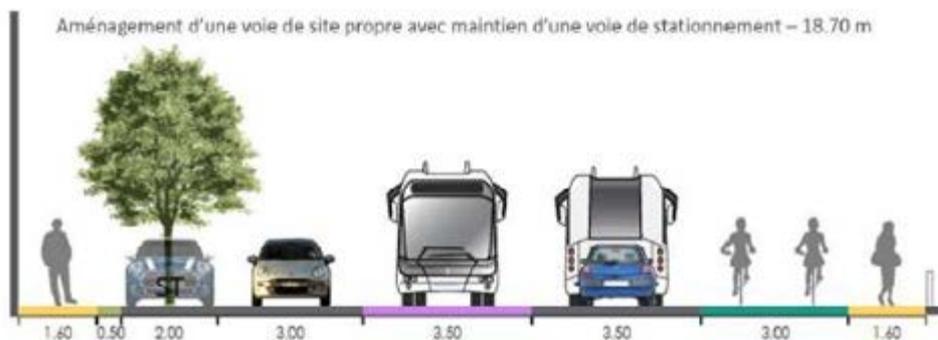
Variante – Aménagement d'une voie de site propre avec maintien d'une voie de stationnement
